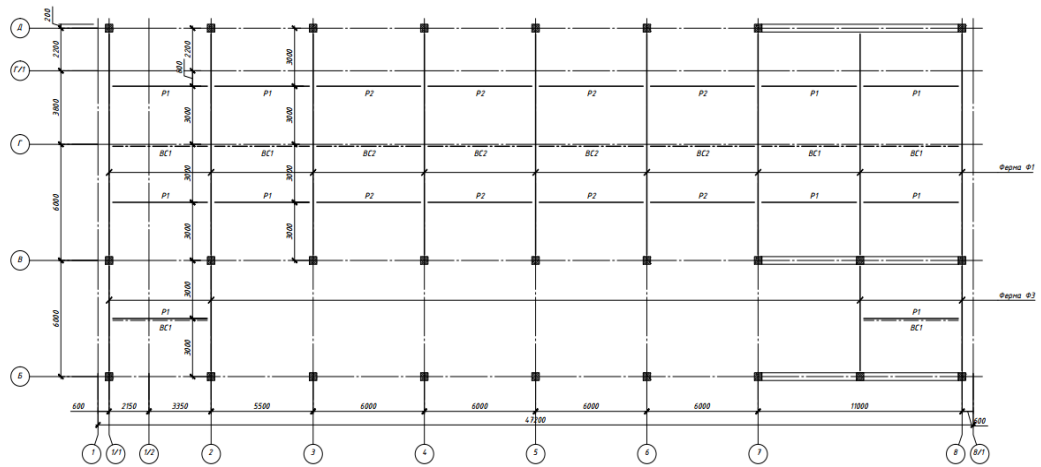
Схема расположения ферм Ф-1, Ф-3 на отм. + 6.350
